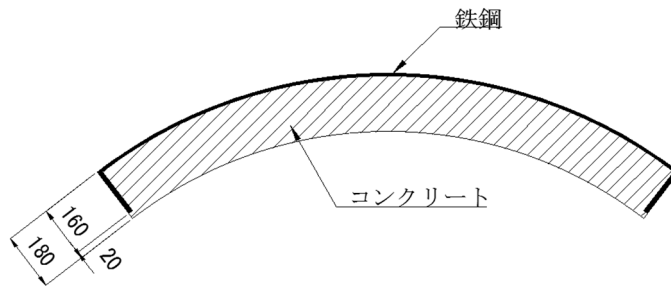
セグメント標準断面図（円周方向）（鉄鋼コンクリート造）
